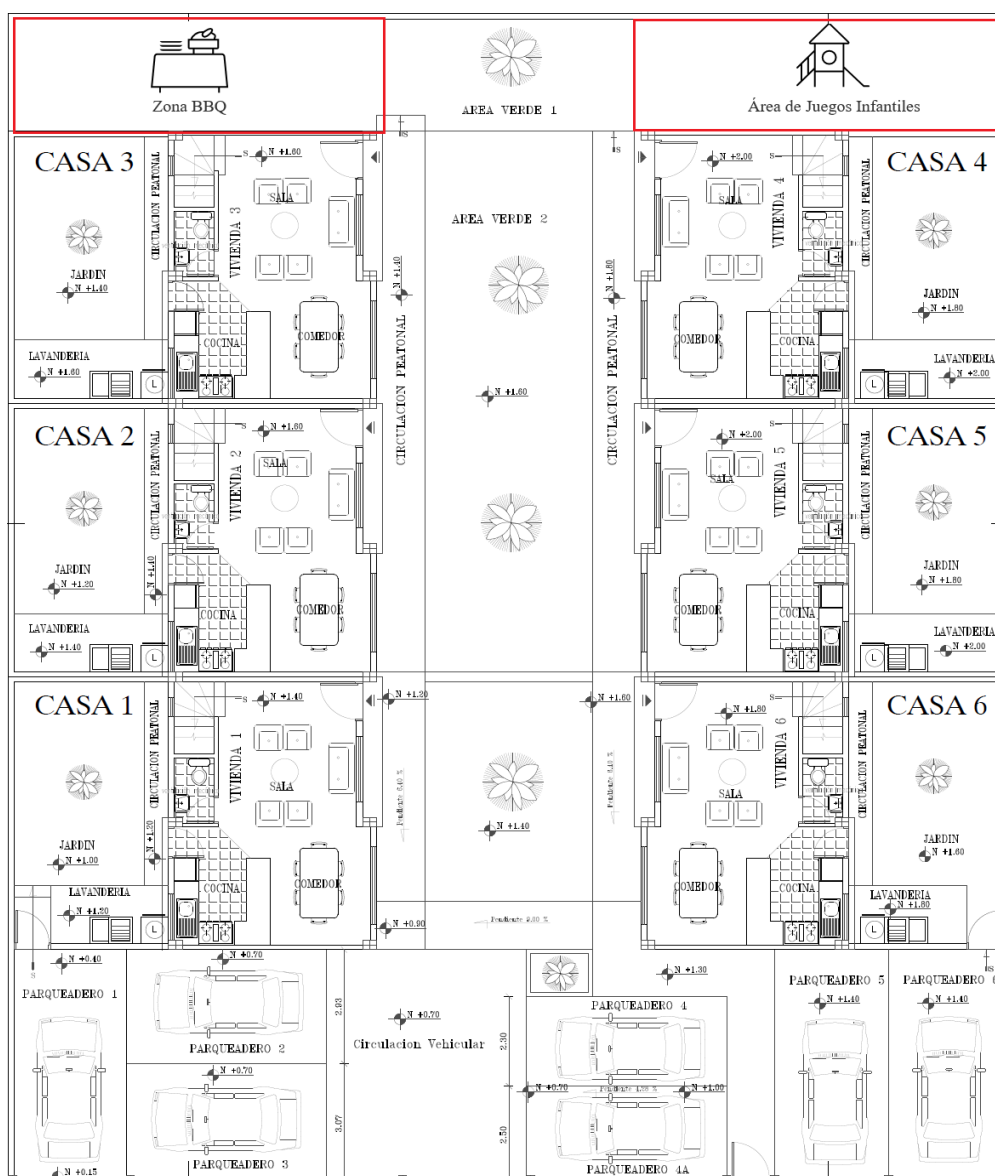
Planos Arquitectónicos – Distribución de Viviendas
